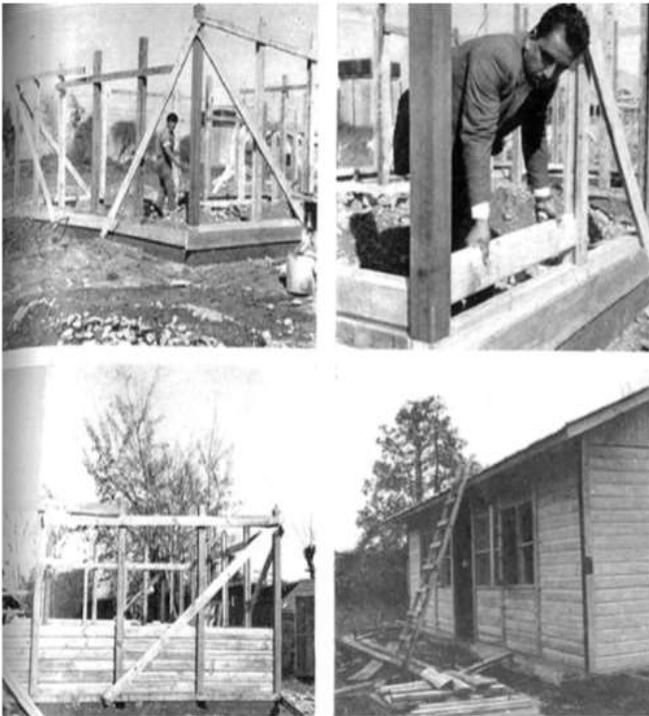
Sistema Constructivo Servanti . Fuente: (Stephanie & Cid, 2018)
